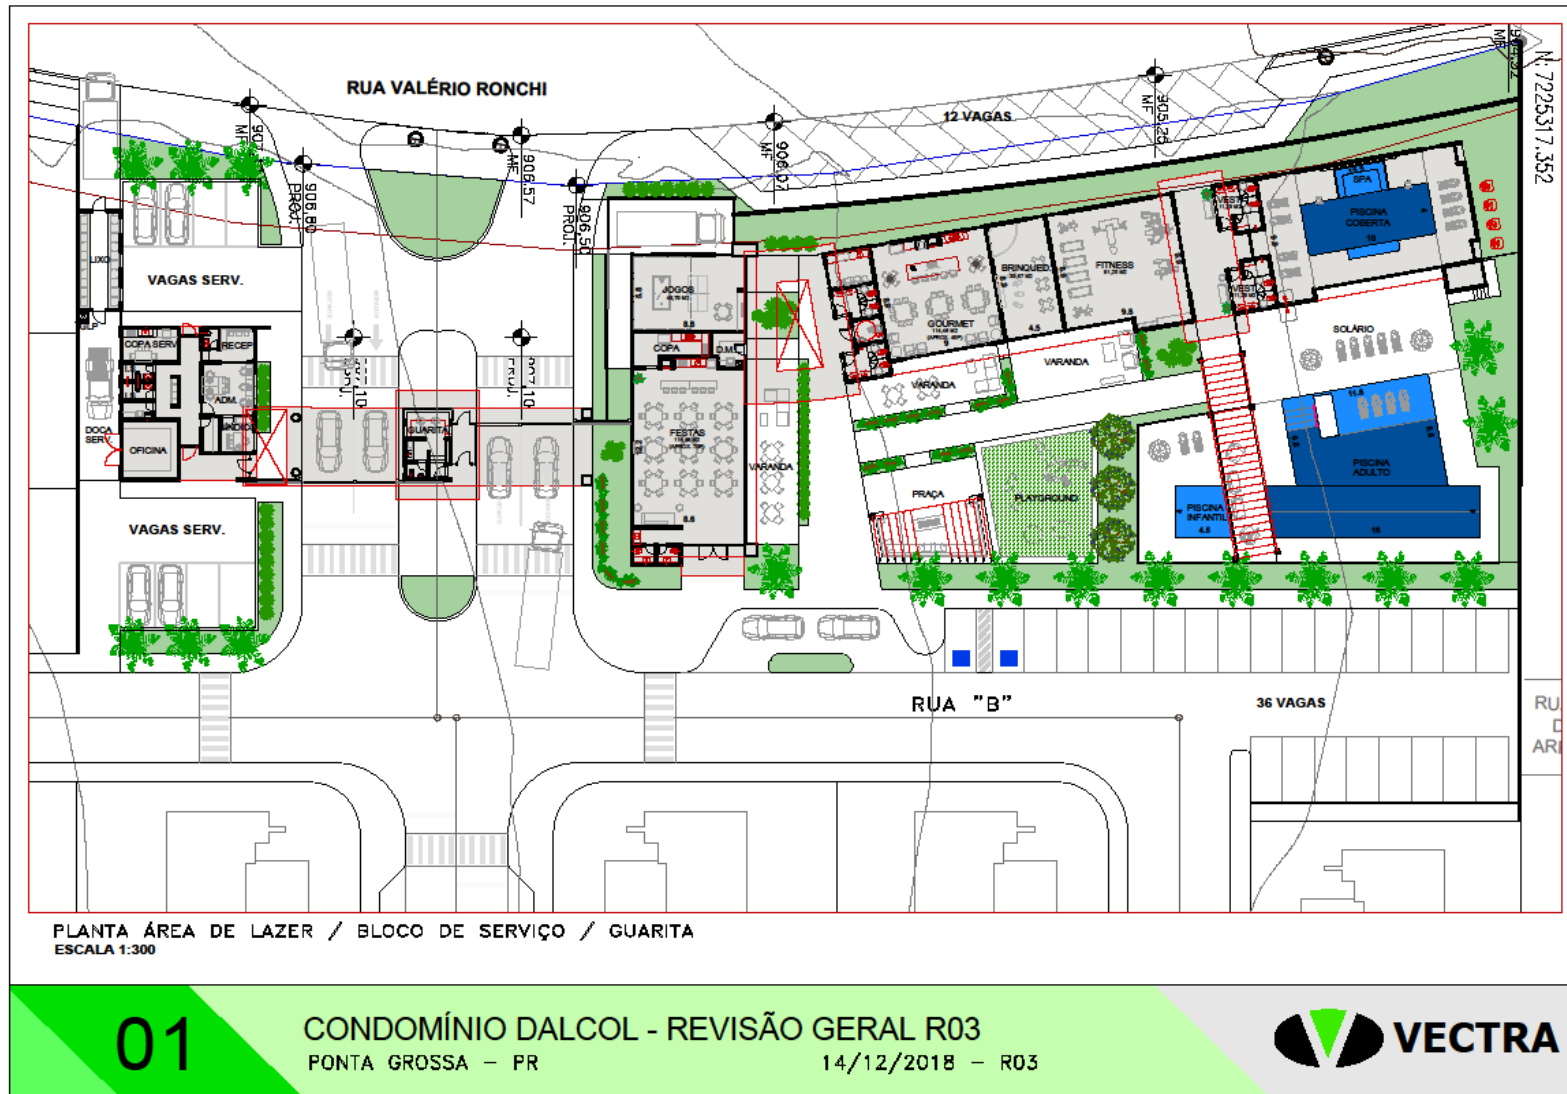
Planta área de lazer / bloco de serviço / guarita.
